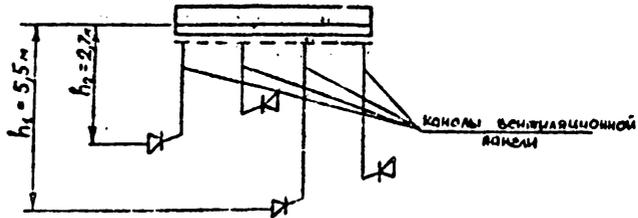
Схема вытяжной системы вентиляции с объединенными каналами.
